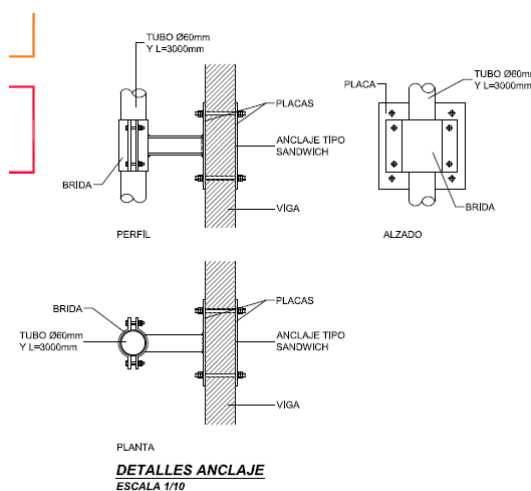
Detalle arquitectónico anclaje a pared de tubo soporte antenas
